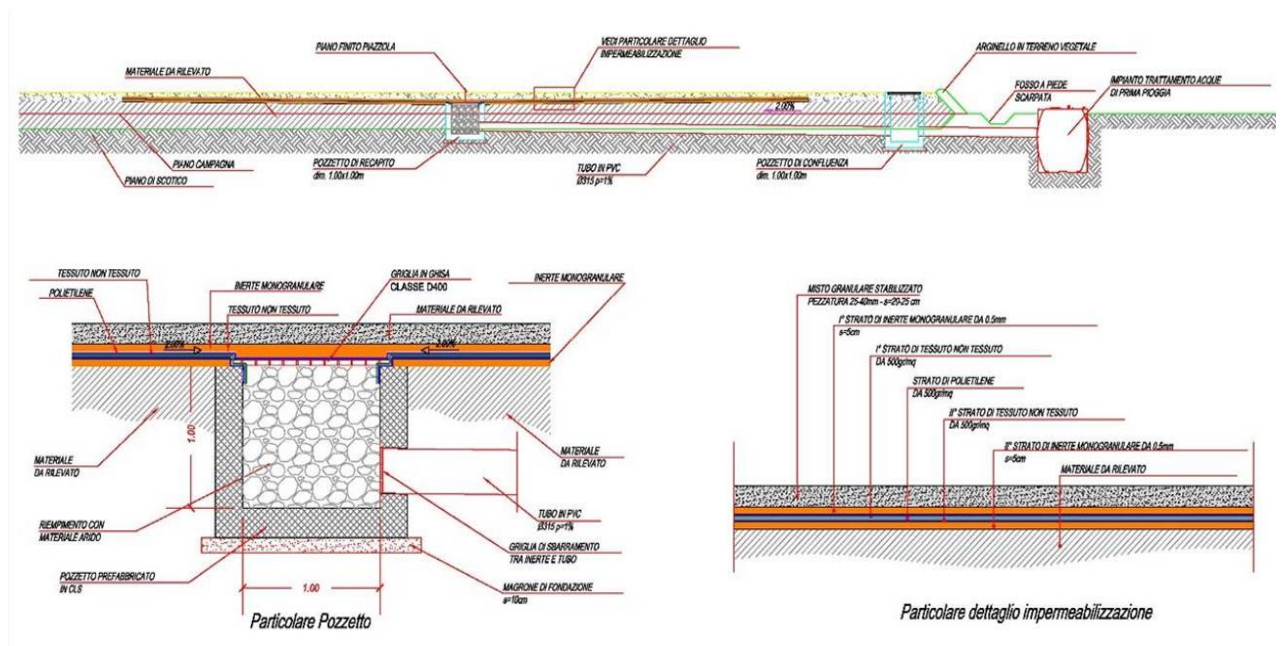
Schema impermeabilizzazione piazzali di cantiere non bitumati
